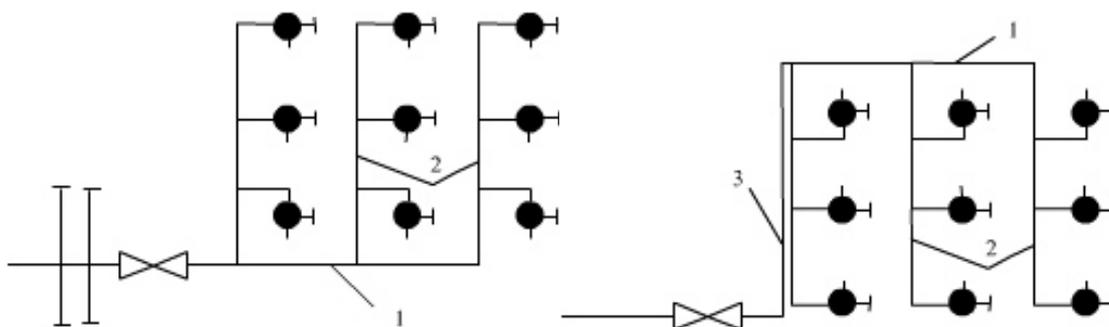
Схема мереж внутрішнього водопроводу з а) нижньою та б) верхньою розводкою
